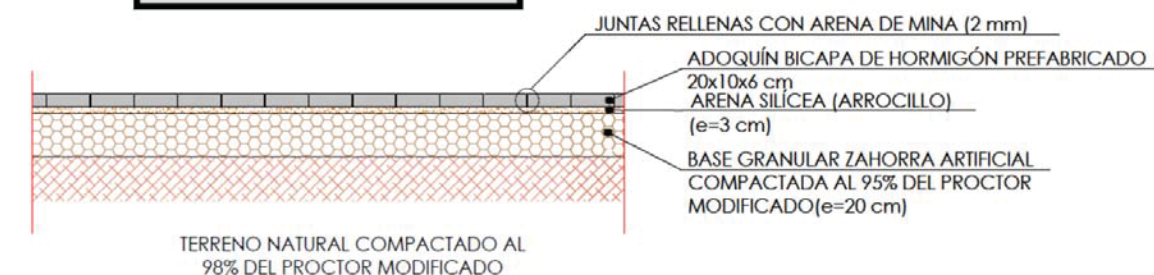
Sección de pavimento en aceras (FUENTE: Elaboración propia).
